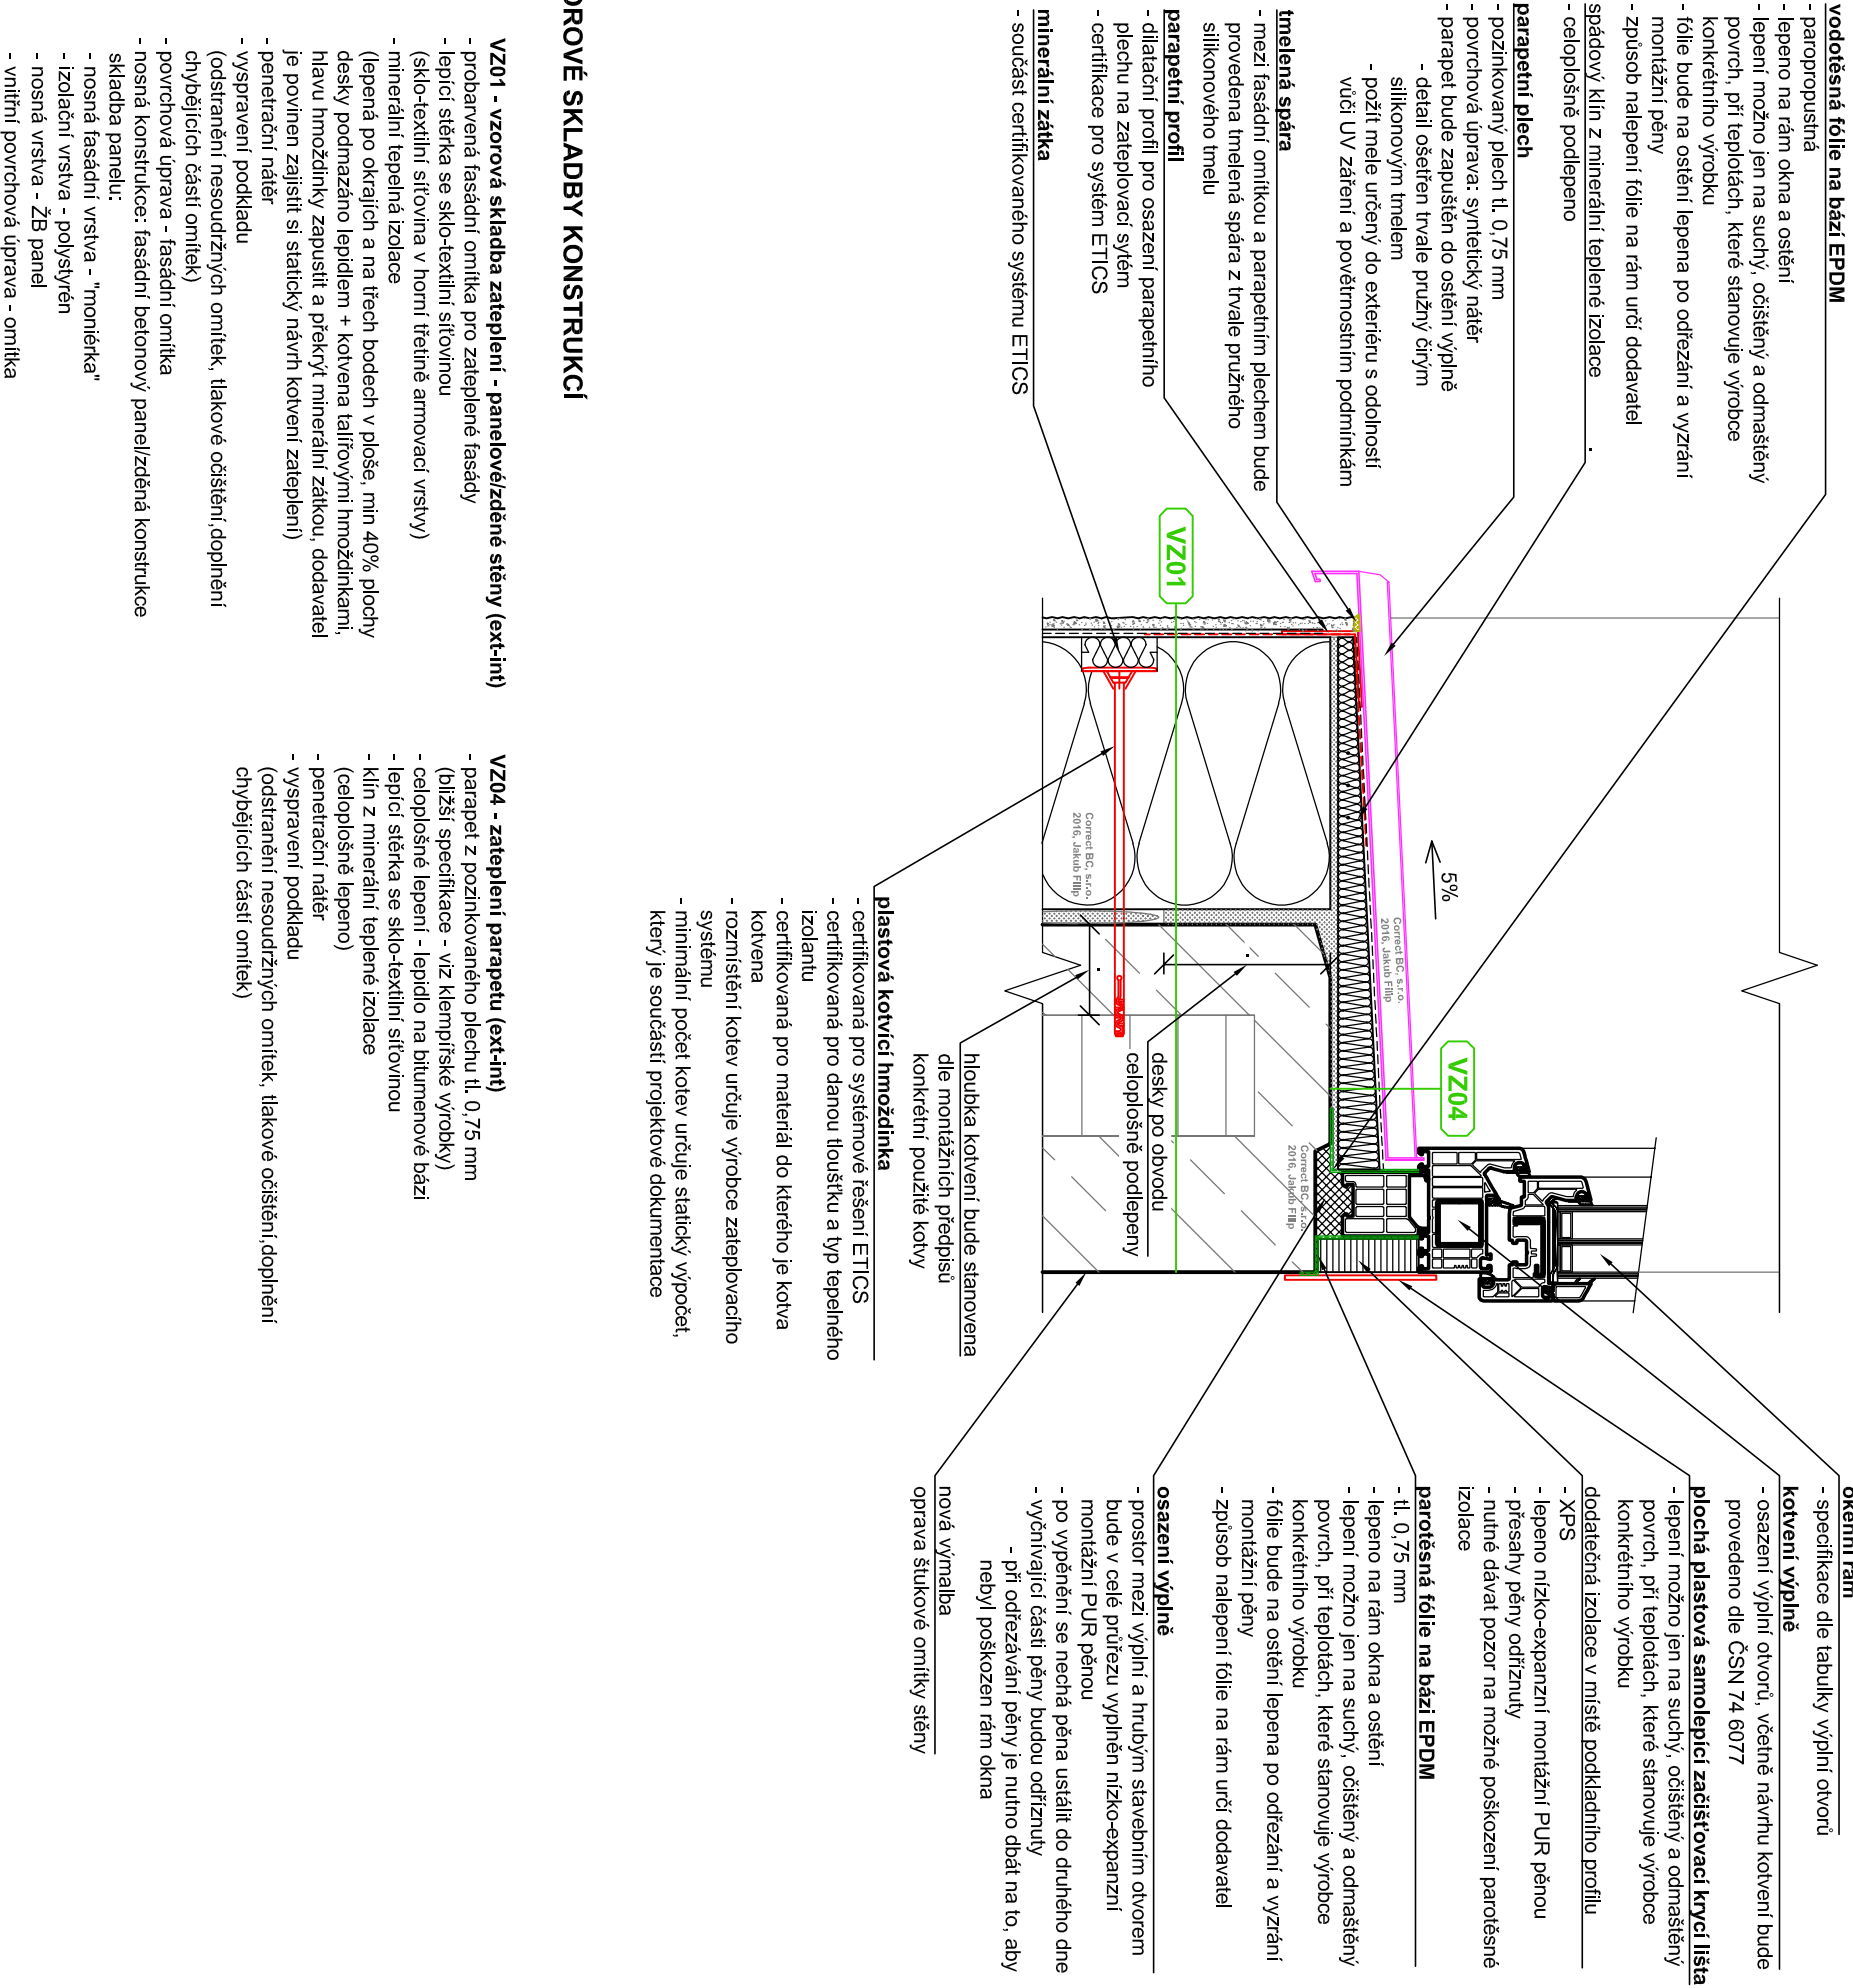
DETAIL OSAZENÍ VÝPLNĚ OTVORU A ZATEPLENÍ U PARAPETU
